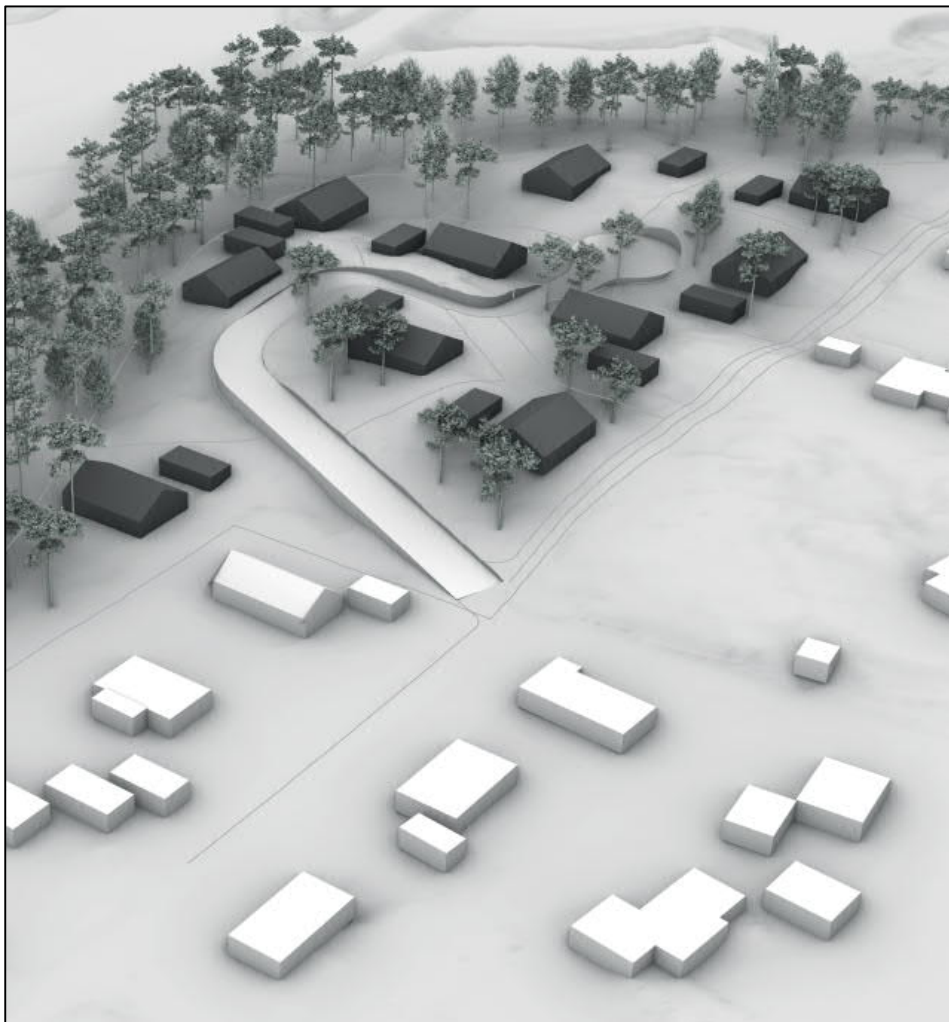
Situationsplan erhållen av beställaren med planerad byggnation.
